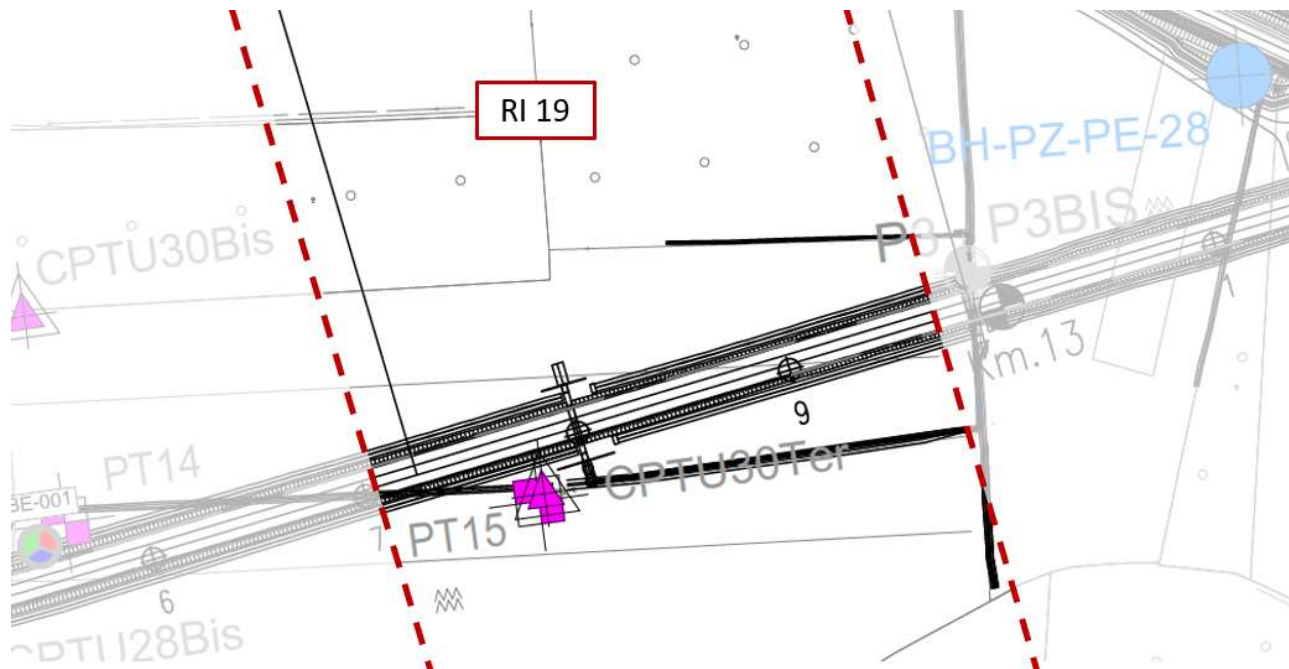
Planimetria Rilevato RI19, estratto dalla Planimetria Generale (Doc. Rif. [3])
